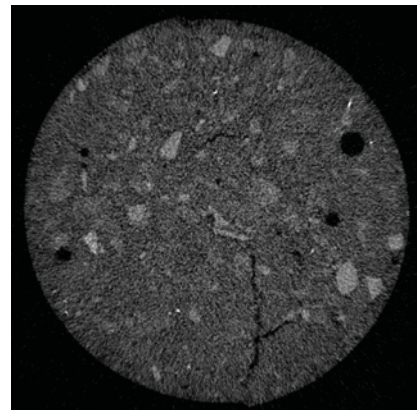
Mini probeta de traviesa con fisura de retracción
